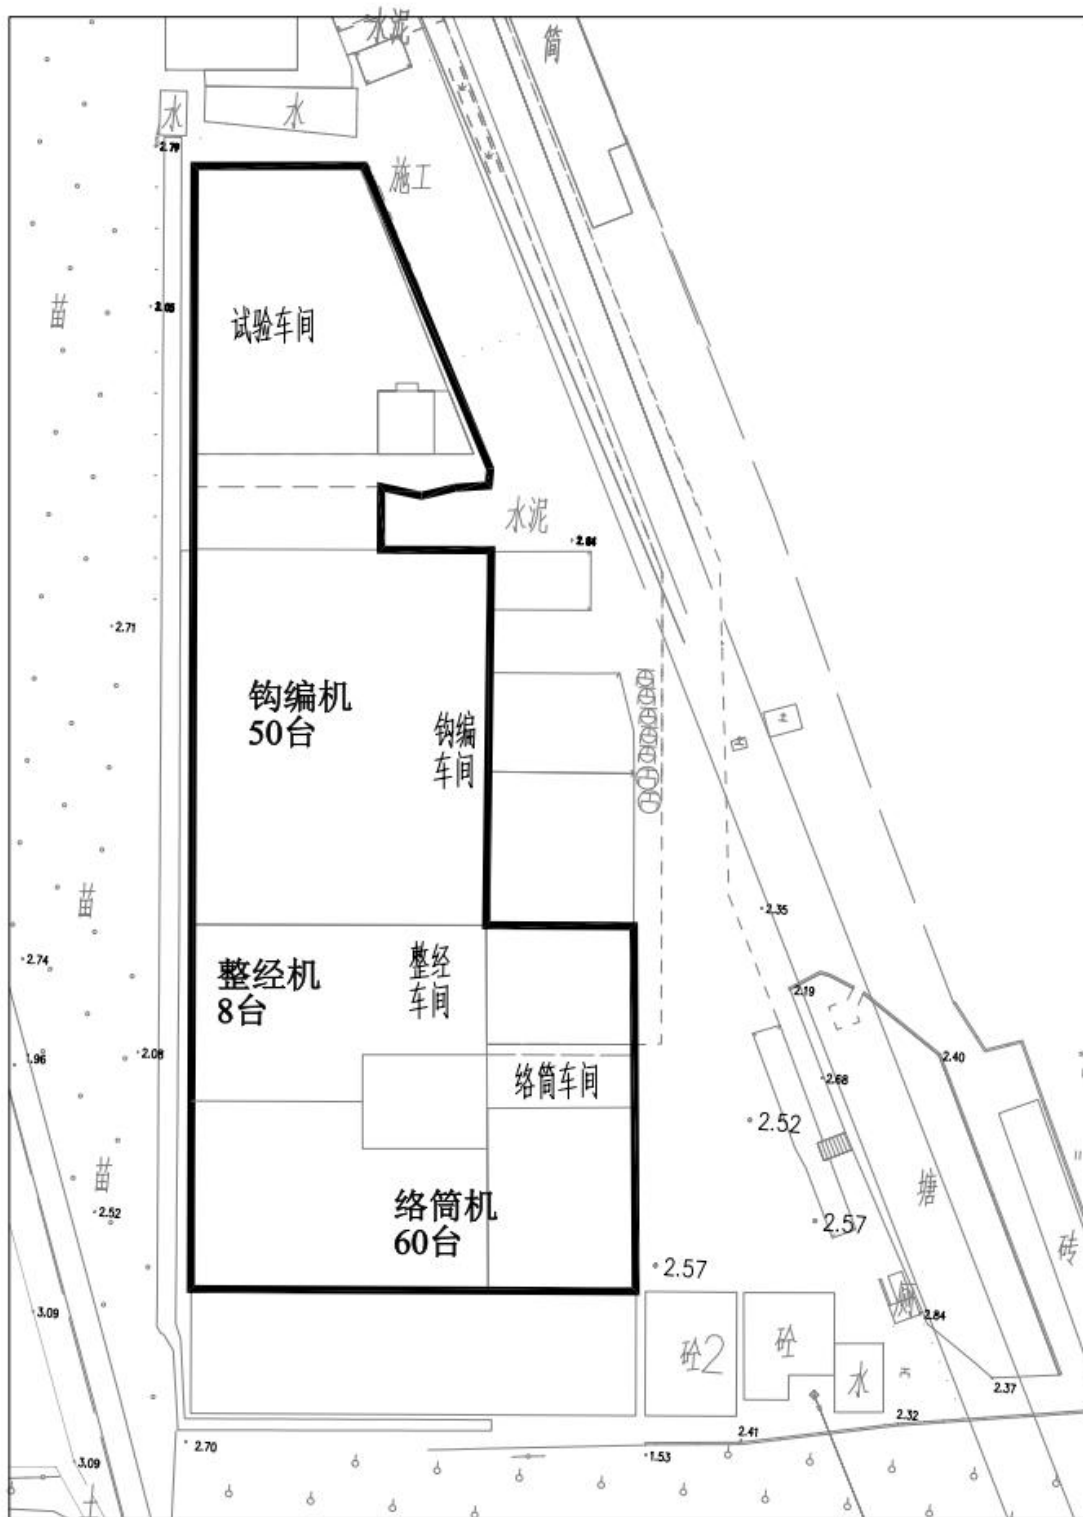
项目二层平面布置图（比例尺 1: 600）
